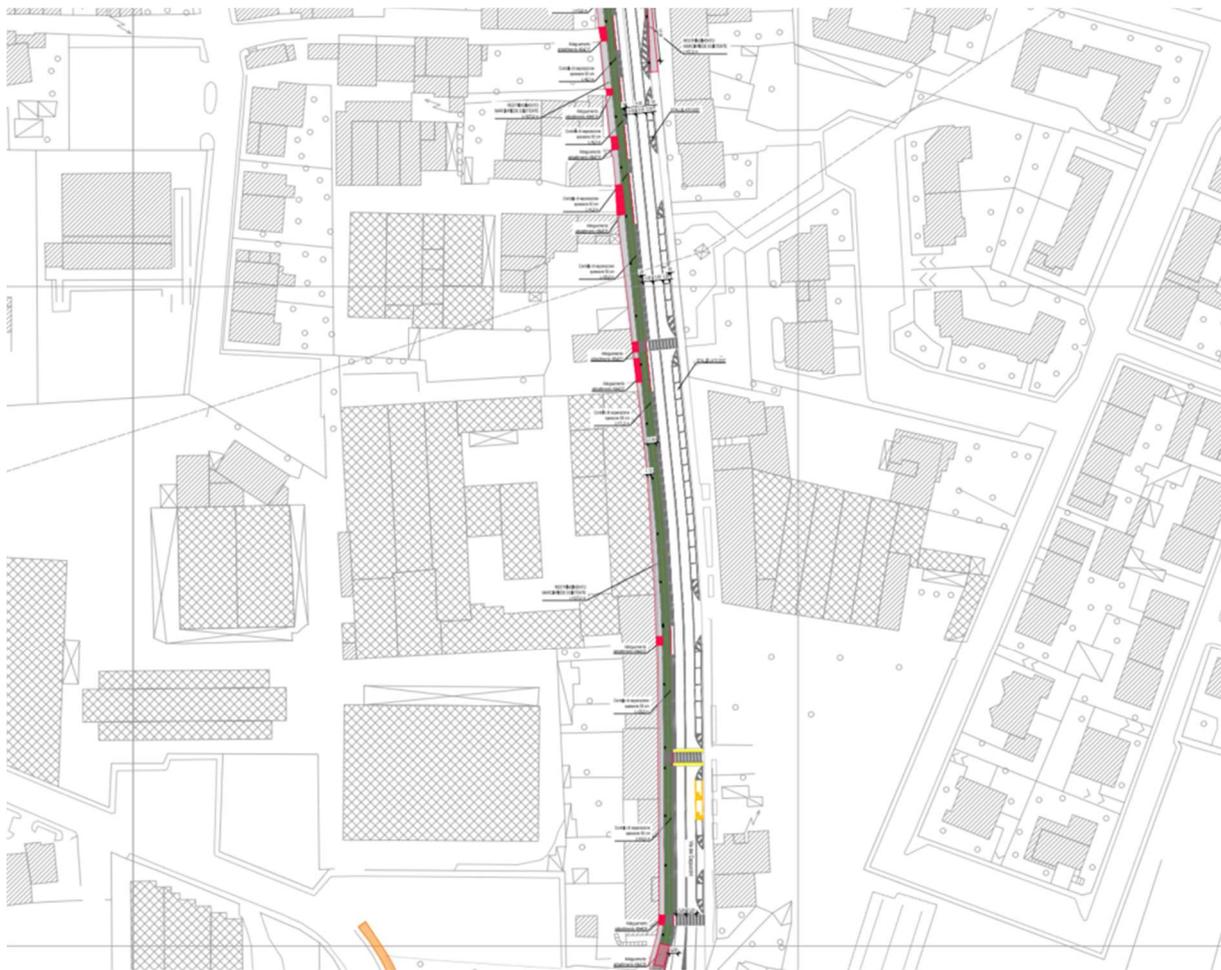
Estratto planimetria interventi WBS\_03 – secondo tratto
